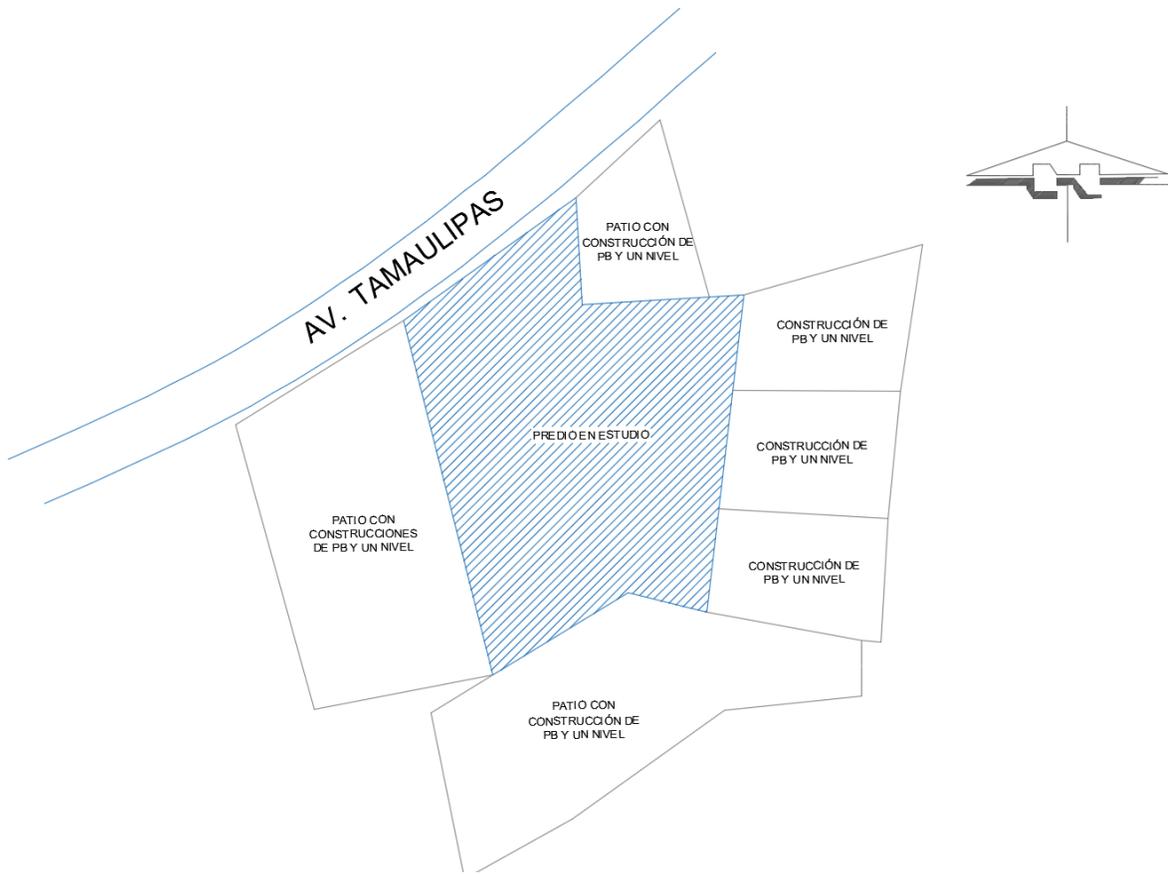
Se indica una planta donde se aprecian las colindancias del sitio de interés descritas
